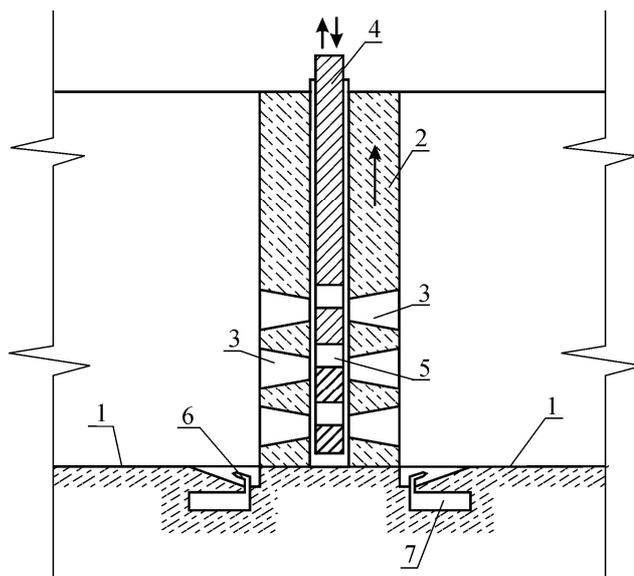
Схема механического рыбопропускного шлюза ПЭС на разрезе: 1 – рыбоходный тракт; 2 – рабочий затвор; 3 – клинкеты; 4 – регулирующая шторка; 5 – водопропускные отверстия регулирующей шторки; 6 – струеобразующие насадки потокообразующего устройства; 7 – напорные коллекторы
